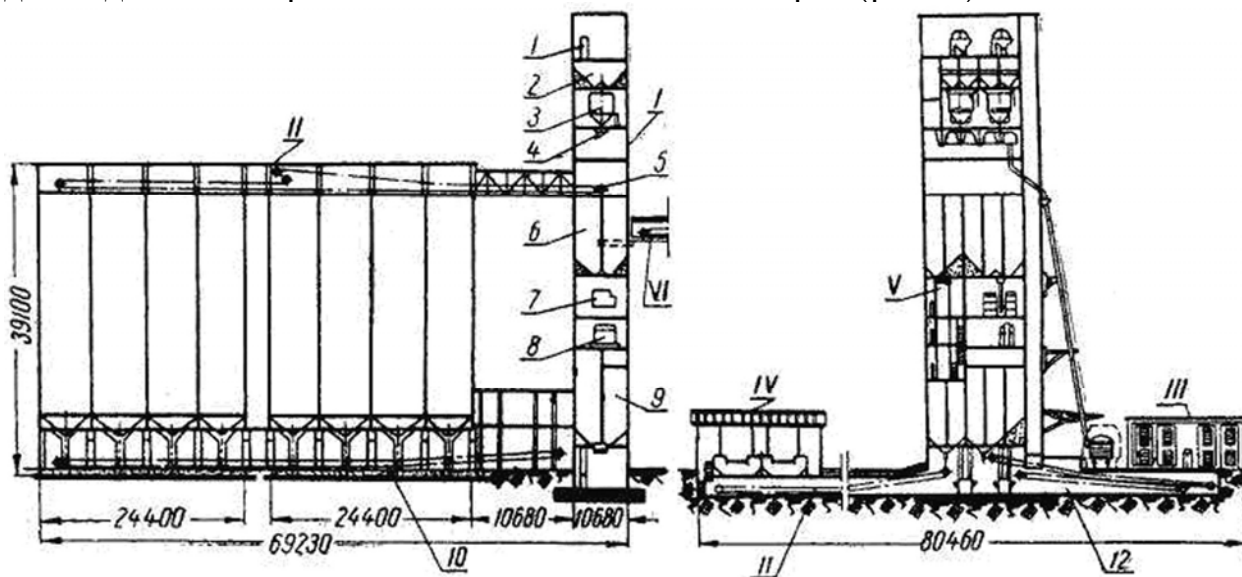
Основні споруди елеватора: робоча вежа (I), силосні корпуси (II), приймальні пристрої з автомобільного та залізничного транспорту (III, IV), зерносушарки (V), галереї сполучення з млином (VI); 1 – норії; 2 – надваговий бункер; 3 – ковшові ваги; 4 – розподільні труби; 5 – надсилосні транспортери; 6 – надсепараторні бункера; 7 – сепаратор; 8 – контрольний сепаратор; 9 – підсепараторний бункер; 10 – підсилосний транспортер; 11 – приймальний транспортер з автомобільного транспорту; 12 – приймальні транспортери з залізничного транспорту
